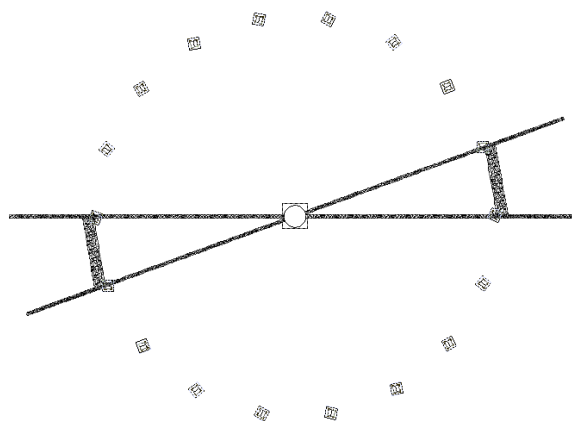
Sectores Montados Simetricamente (Planta).
